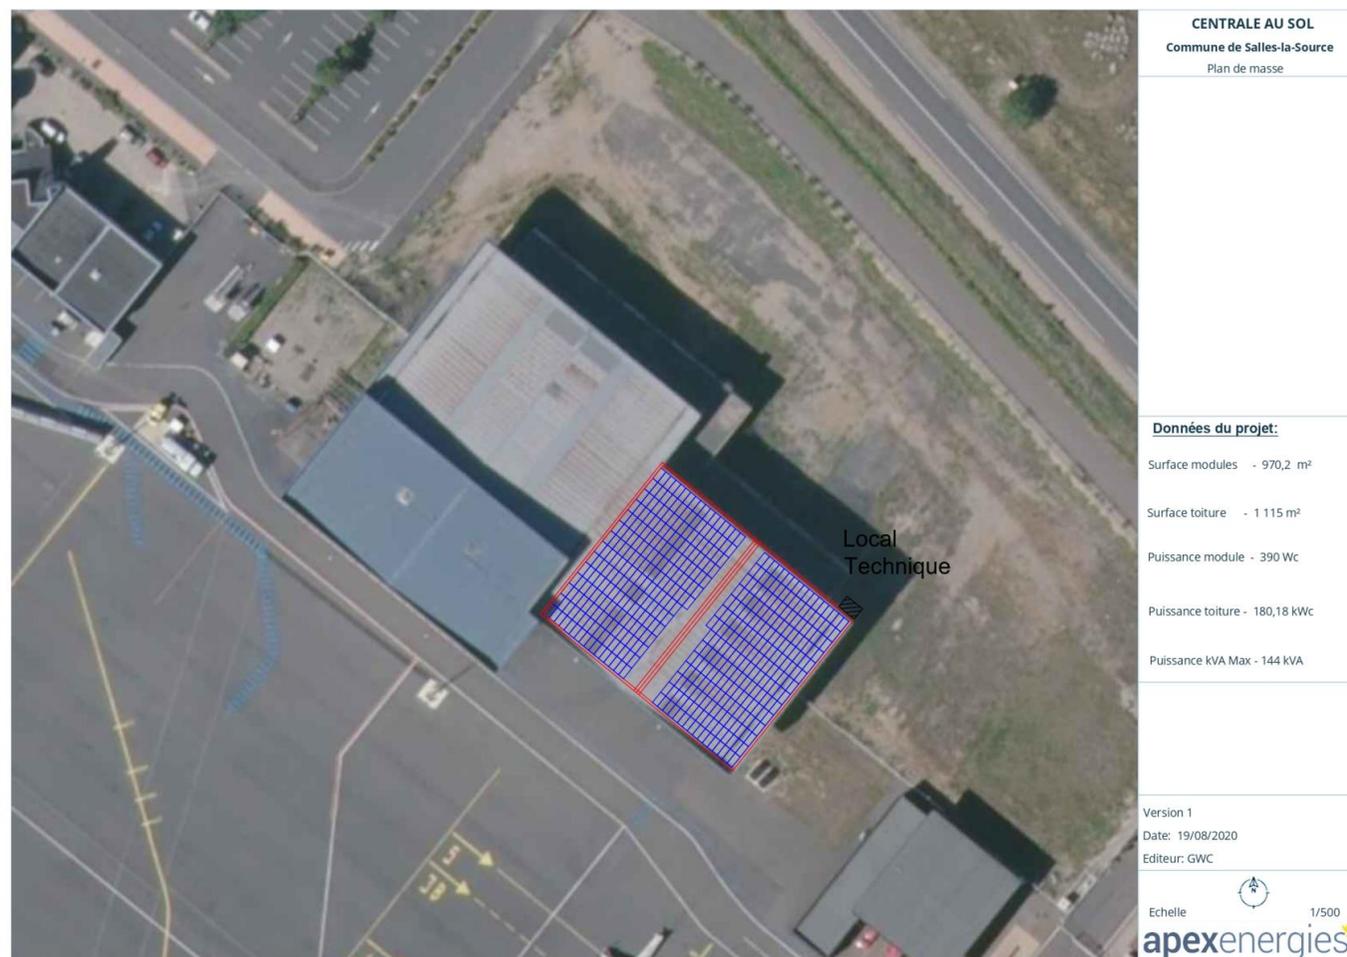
Plan de masse de l'option n°2 de centrale sur Hangar autoconsommation
